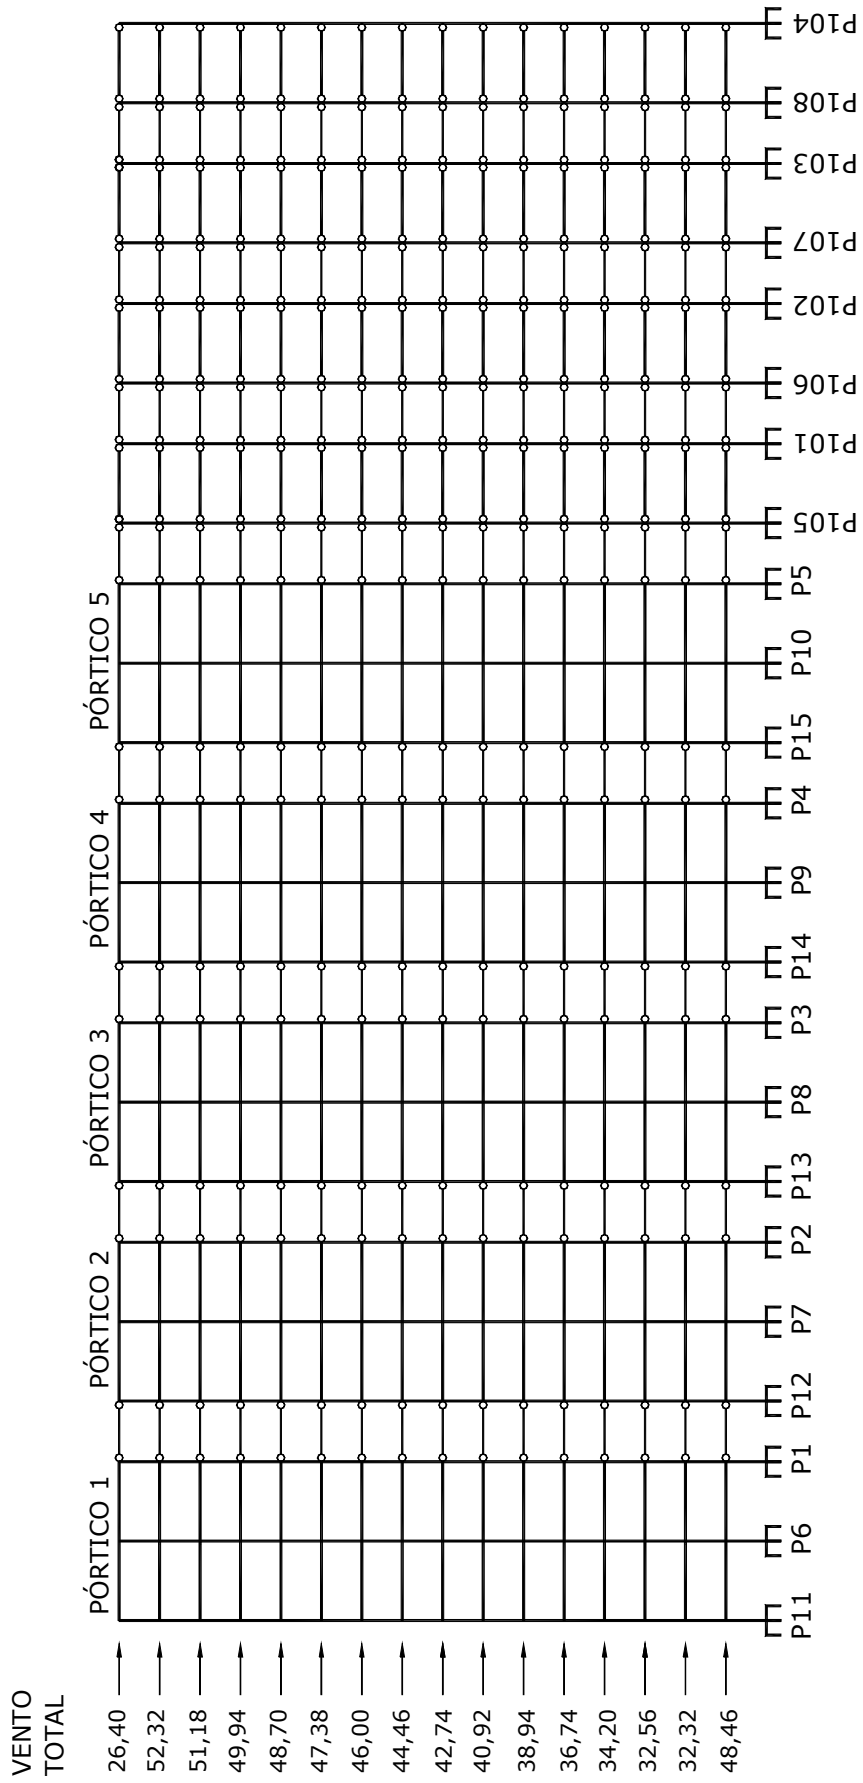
Modelo Pórticos Planos Alinhados (PPA) da Estrutura 2: elevação dos pórticos e esquema do carregamento (em kN).
